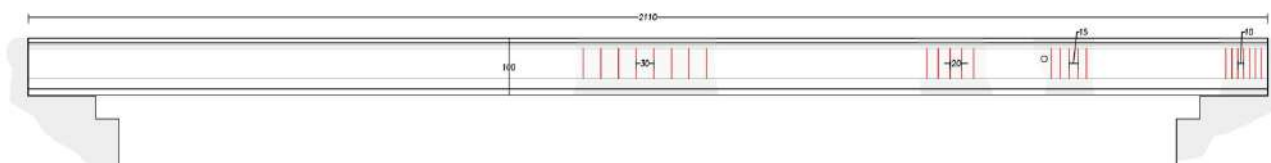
SEZIONE LONGITUDINALE DELL'IMPALCATO
